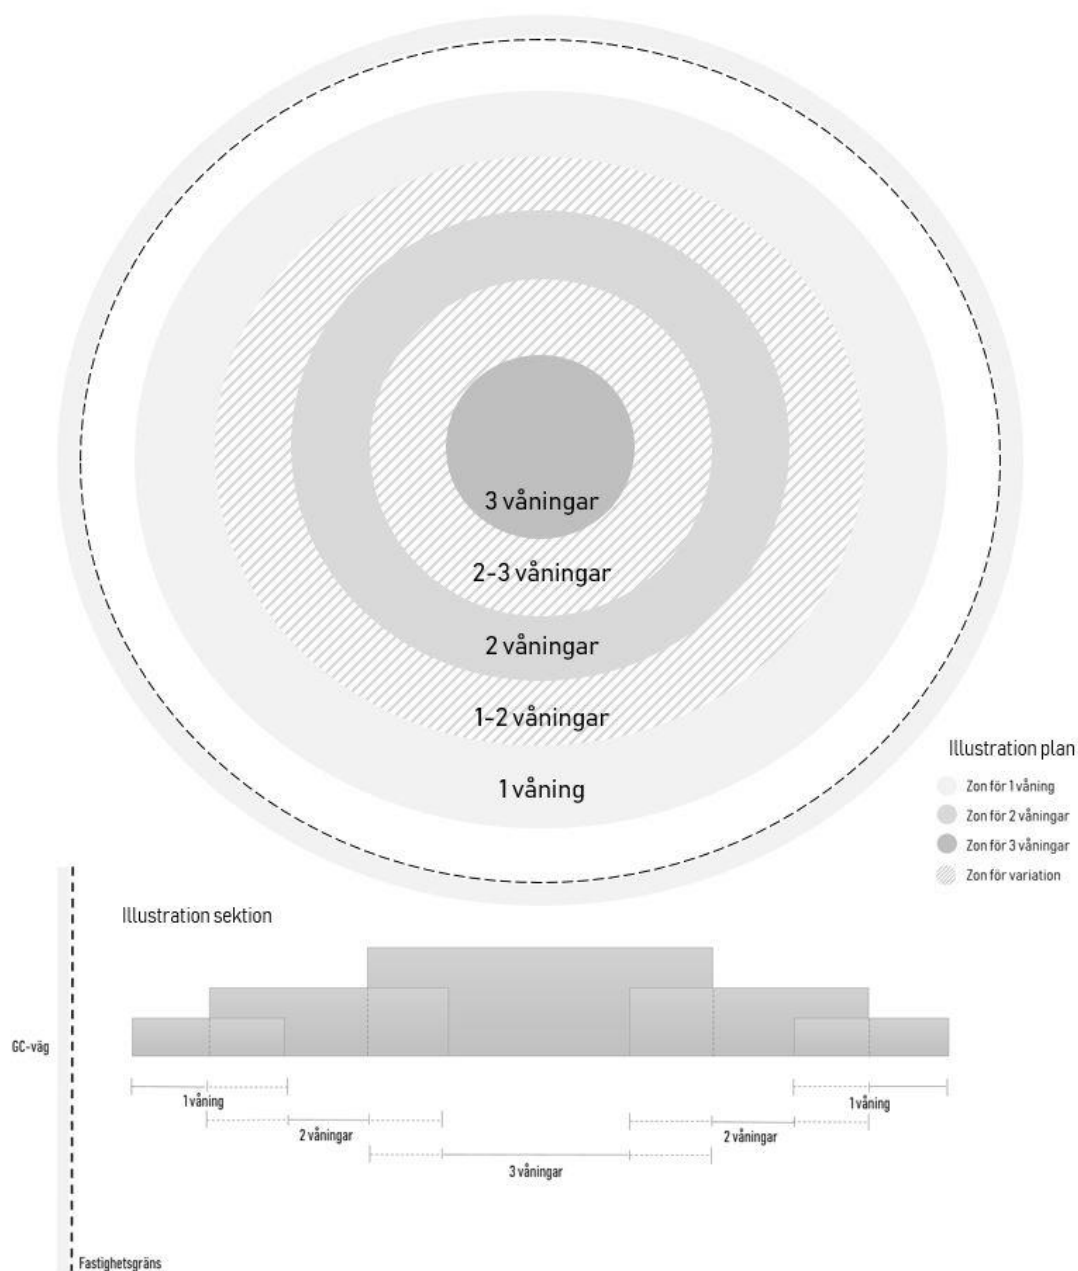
Sektionsspil A i detaljplan som reglerar möjlig utformning av våningsplan. Skissen är spegelvänd och hämtad från illustration på plankartan.
